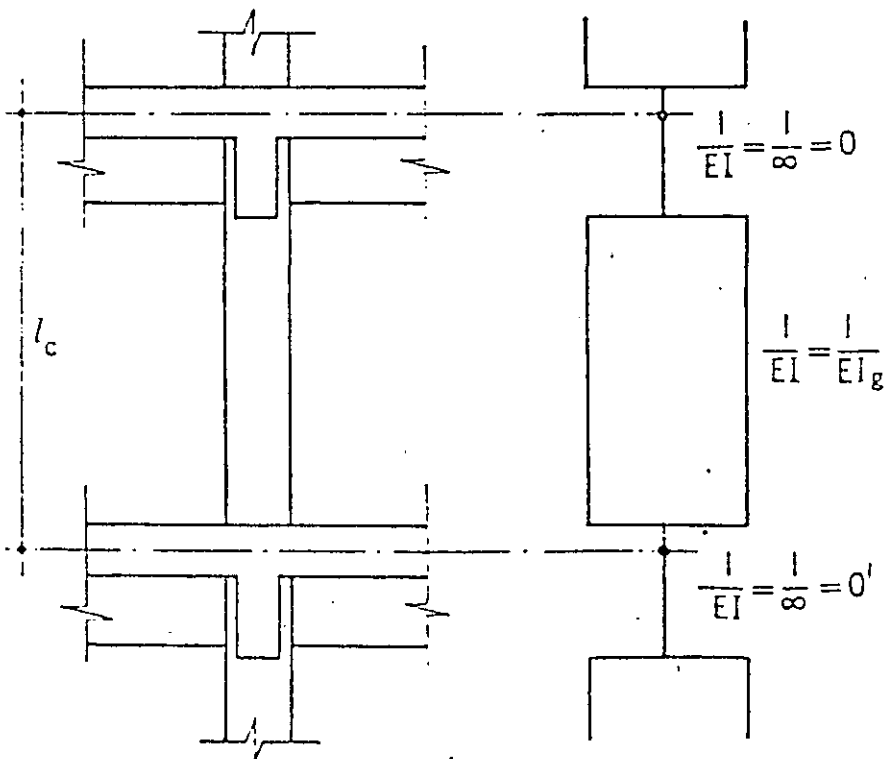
Cálculo de la rigidez a flexión de las columnas equivalentes en sistemas con vigas
